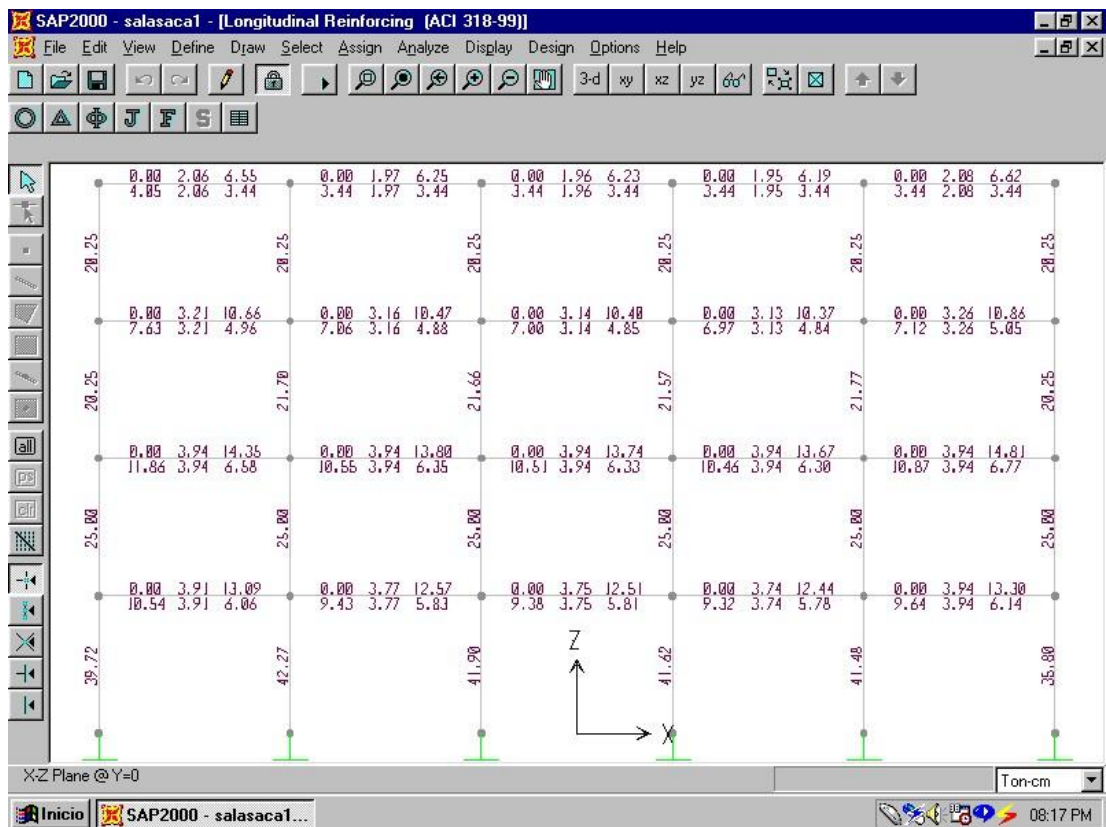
Reforzamiento longitudinal ACI 318-99 (vigas y columnas).
